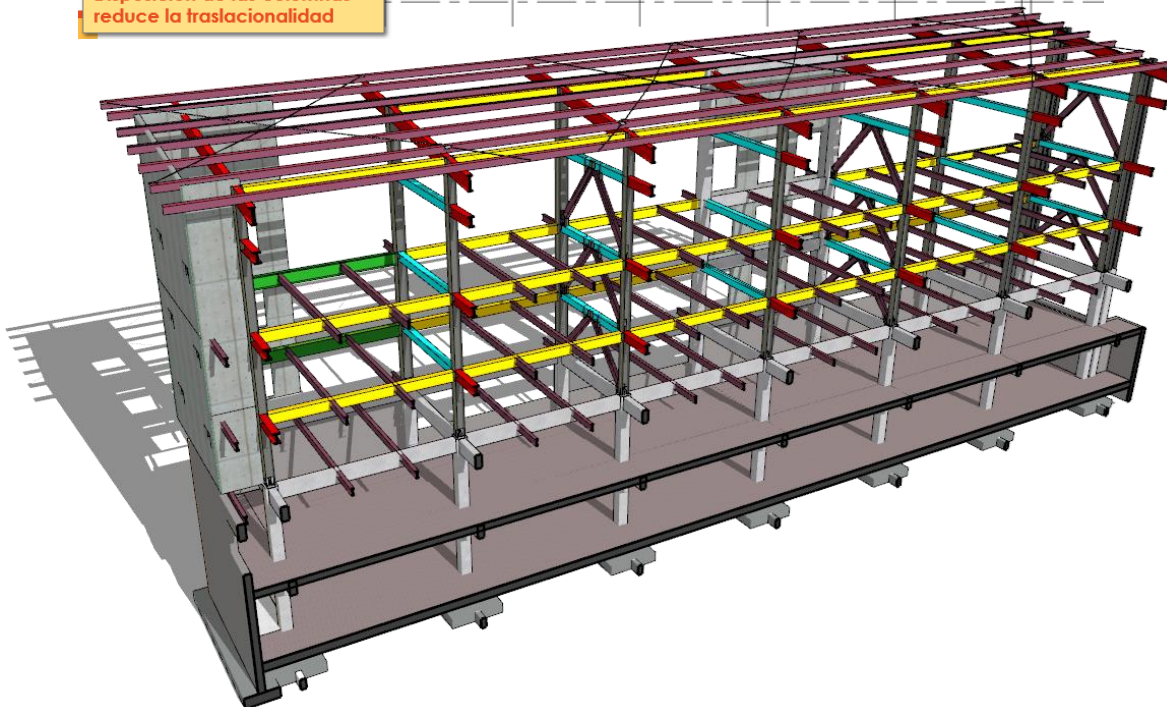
Aplicación de gráficos de predimensionado y ubicación de las columnas de acero en la planta estructural. Fuente: Elaboración propia basada en: Gandica, A. C. - Gráficos para el predimensionado de estructuras. Universidad de los Andes
